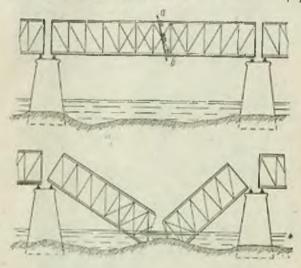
Схема подрывания ферм посредине: а - 6 — места перебивания ферм
